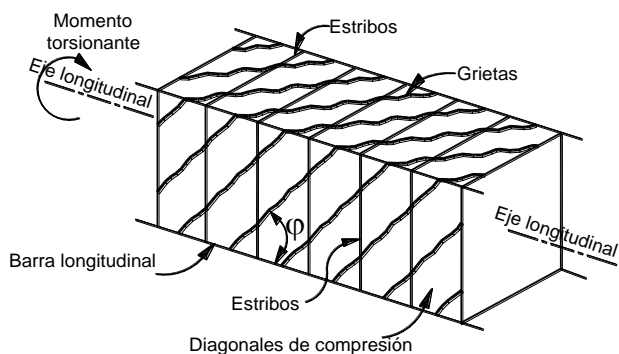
Analogía de la armadura espacial, en torsión pura
